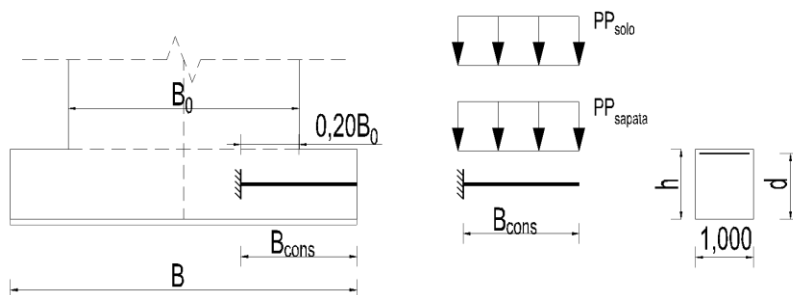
Modelo de cálculo das armaduras da face superior na direção X
